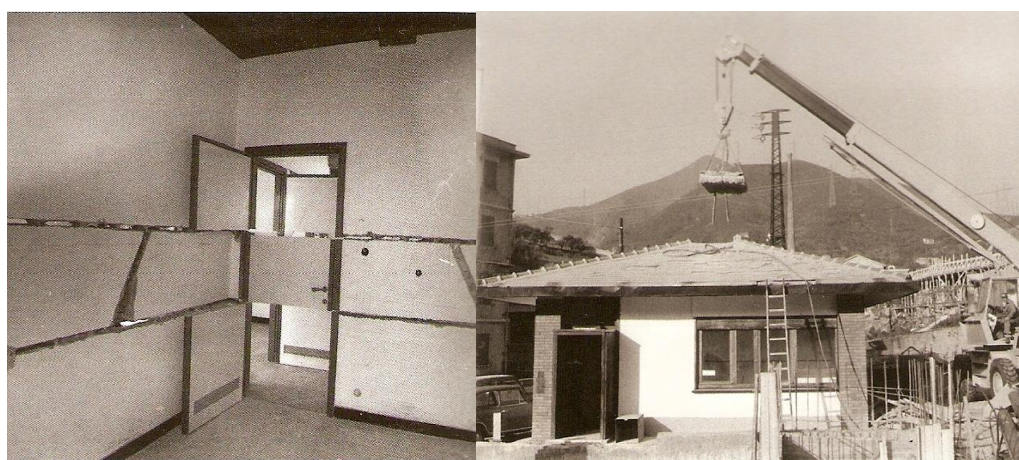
A W-Hole House: Roof Top Atrium*, 1973, vista interior.
